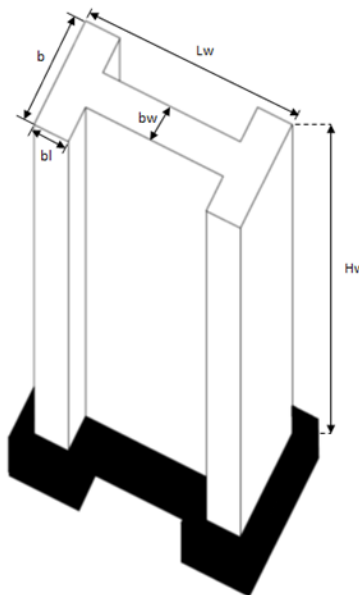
Esquema con la geometría típica de un muro de hormigón reforzado, adaptada de [1].
